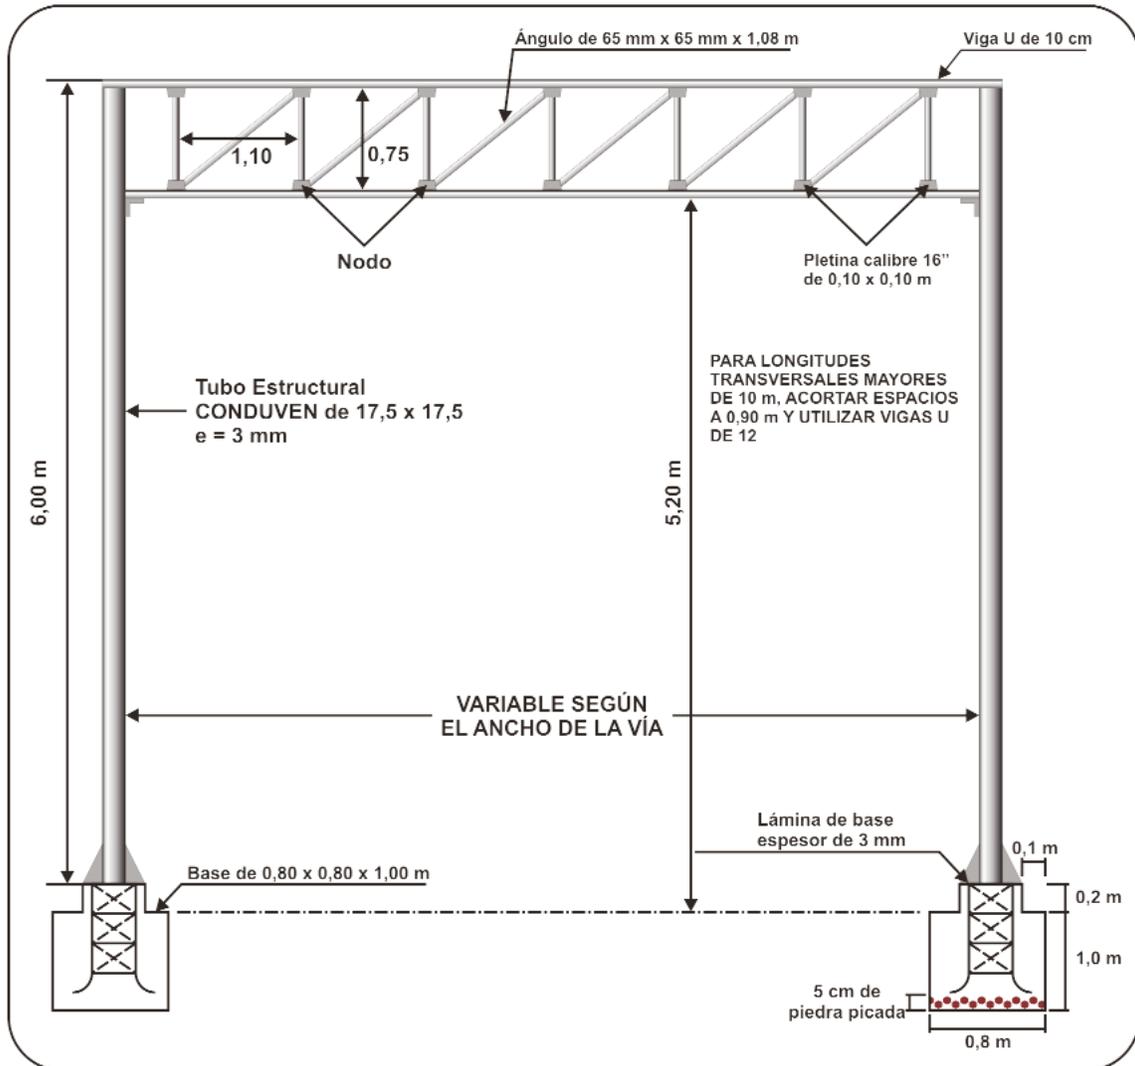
Construcción de cercha para longitudes mayores de 10 m
